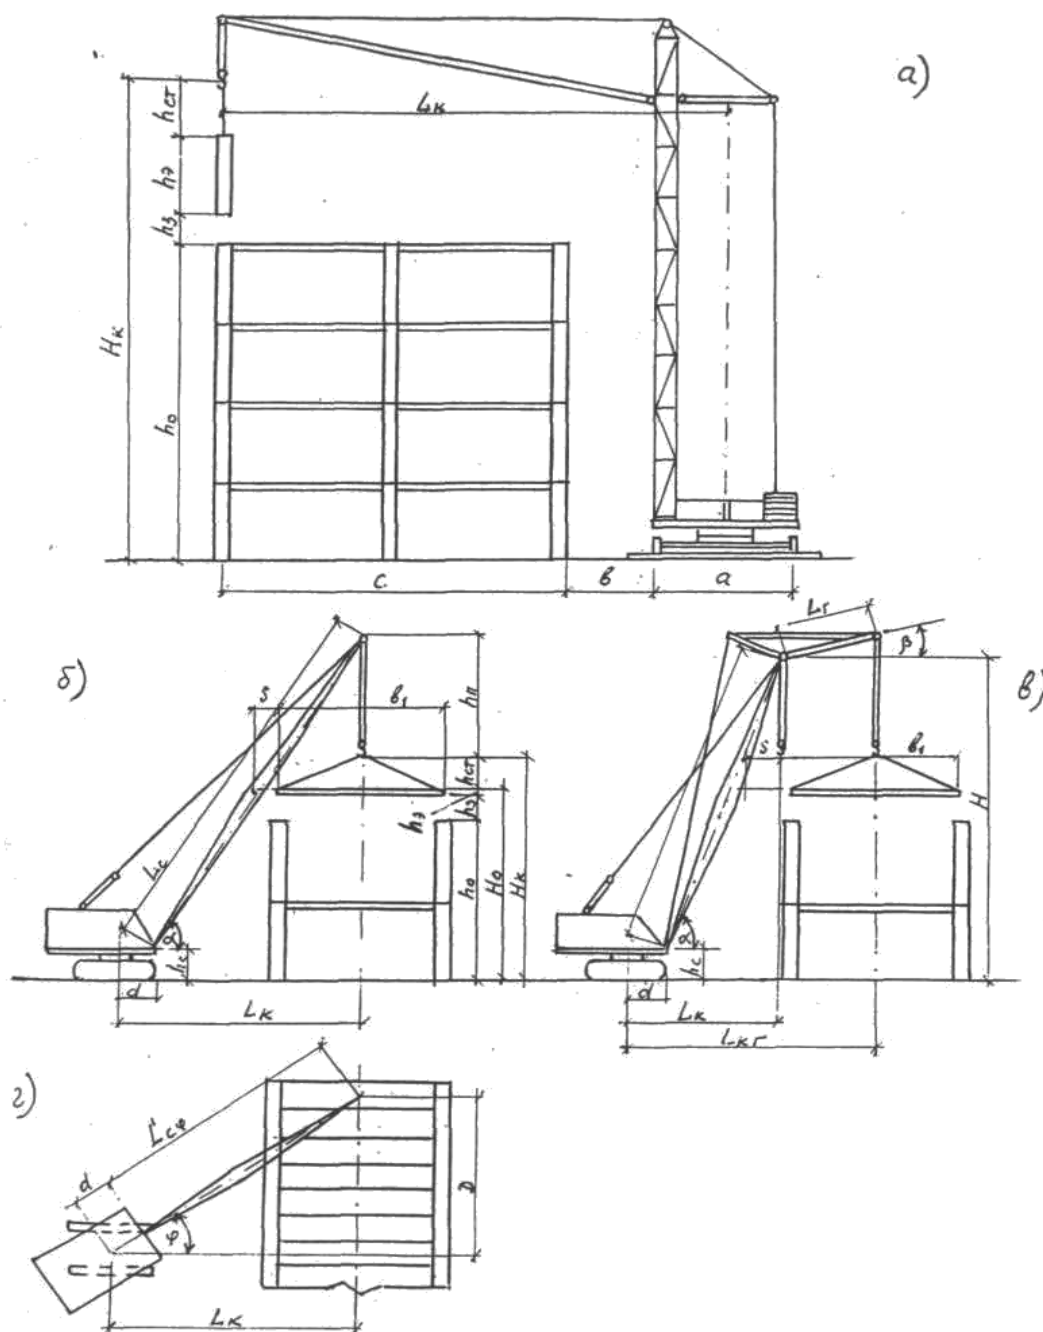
, – а – Схемы для определения требуемых технических параметров монтажного крана: а – башенного; б – самоходного без гуська; в – с гуськом; г – без гуська с поворотом в плане
